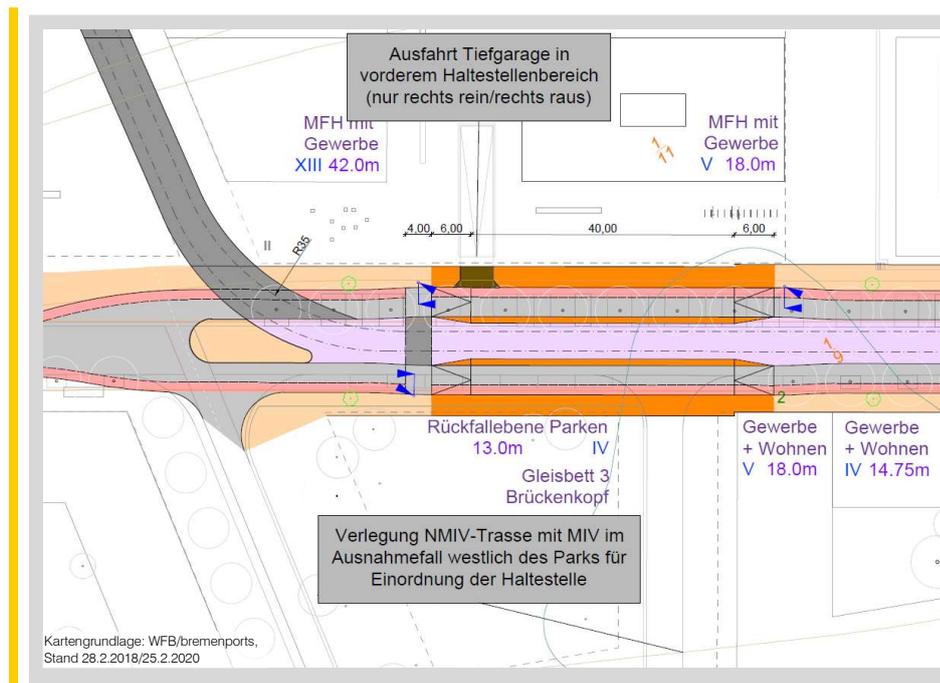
Ausschnitt Lageplan Haltestelle Überseeinsel Nord
